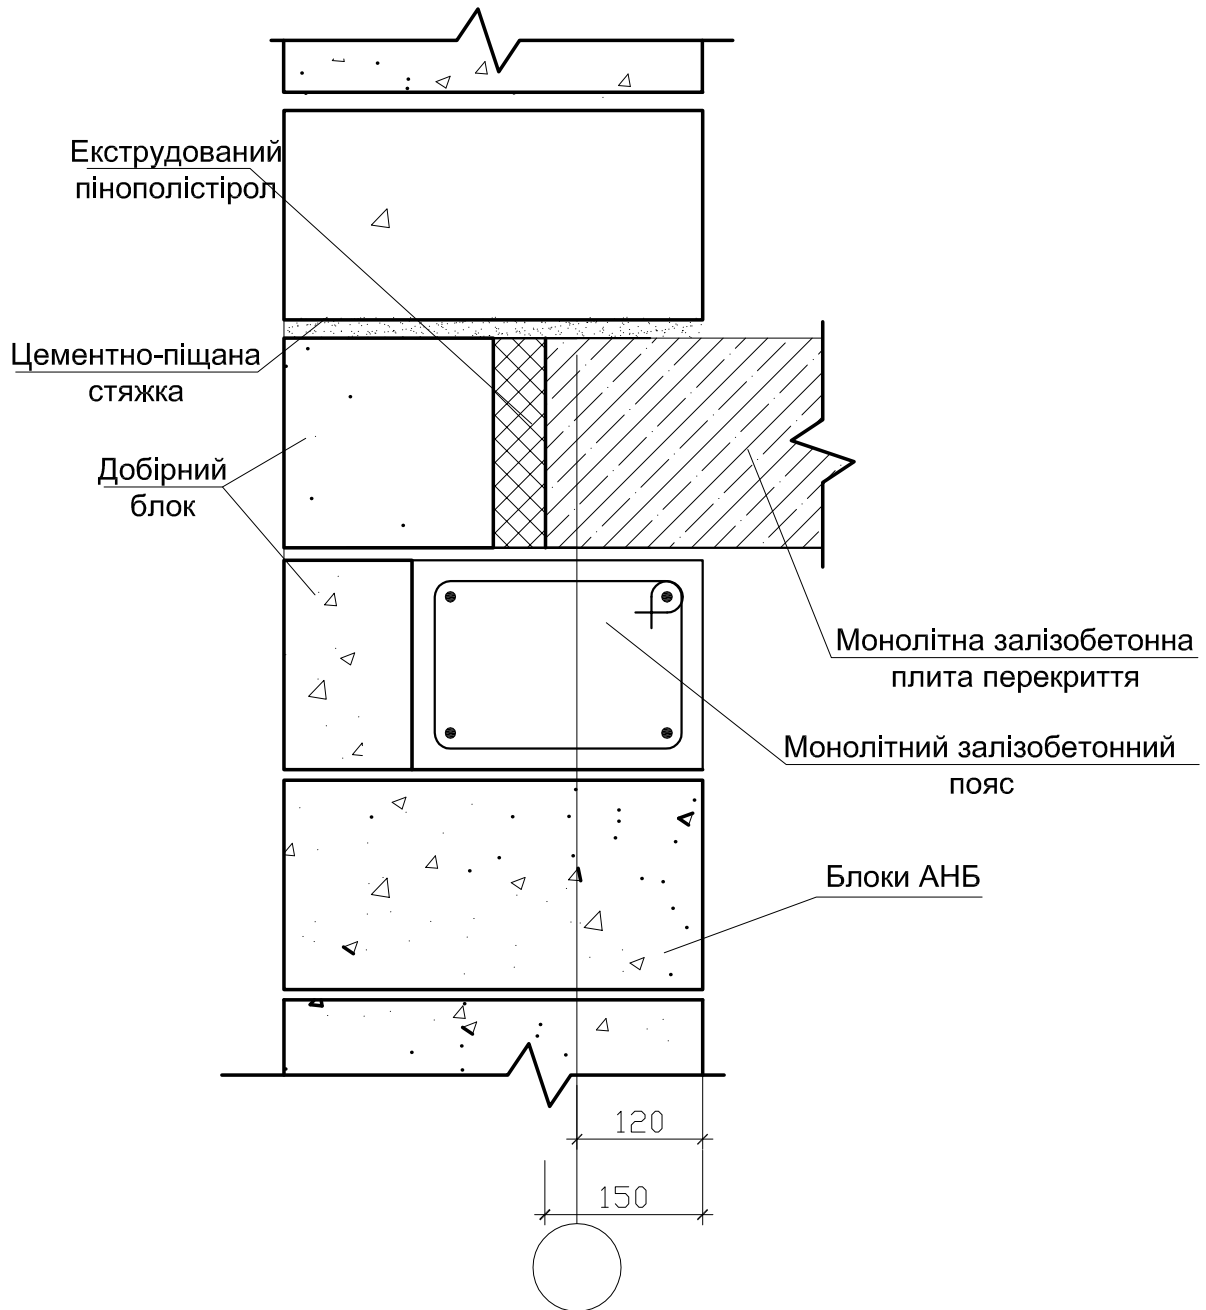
Спирання монолітного залізобетонного перекриття на монолітний пояс при прогонах 7,2 м
